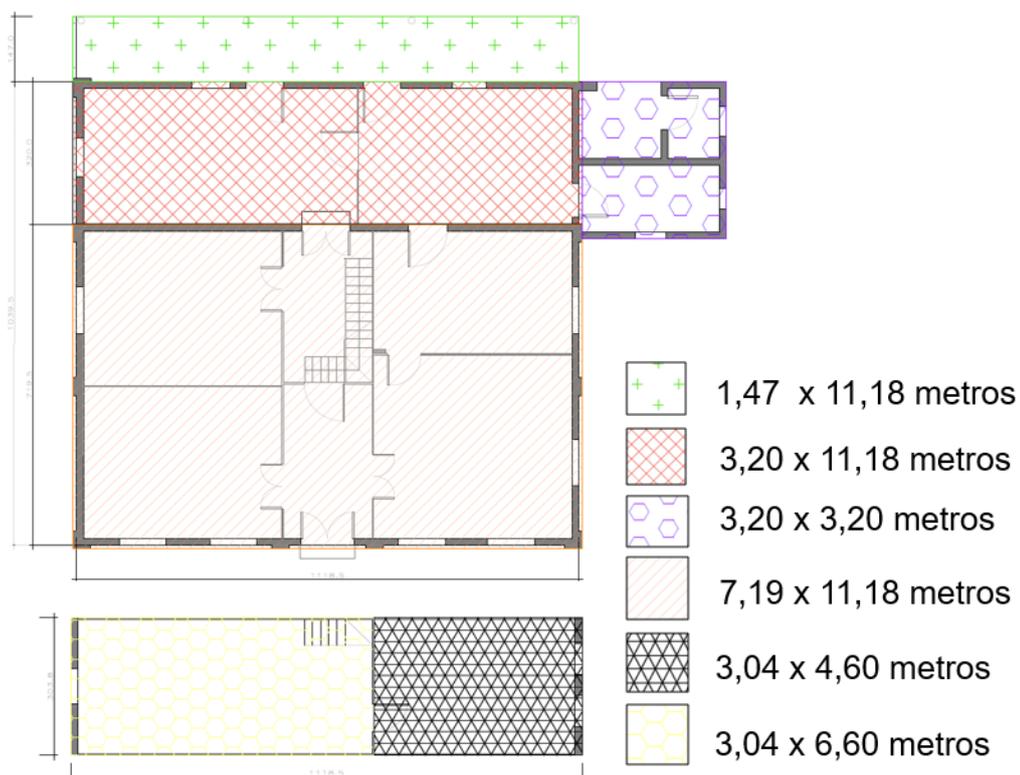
ESQUEMA GERAL DA PLANTA
